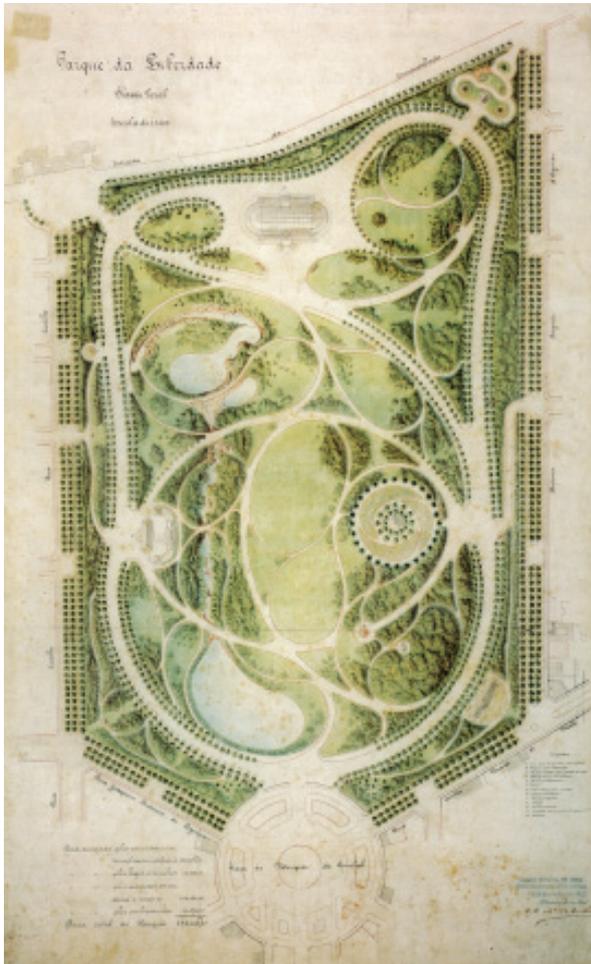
Parque da Liberdade. Planta Geral, 19 de dezembro de 1899
